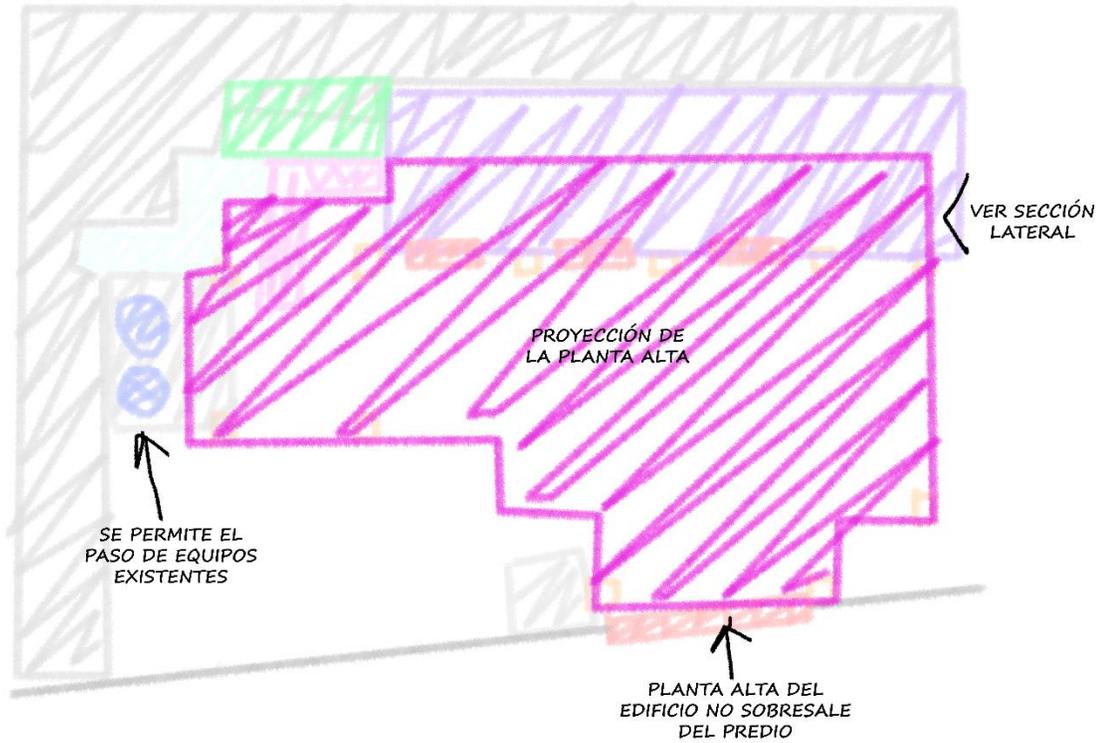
Croquis de proyección de edificio, huella sobre planta baja [Croquis] Elaboración propia. (2023) CDMX
